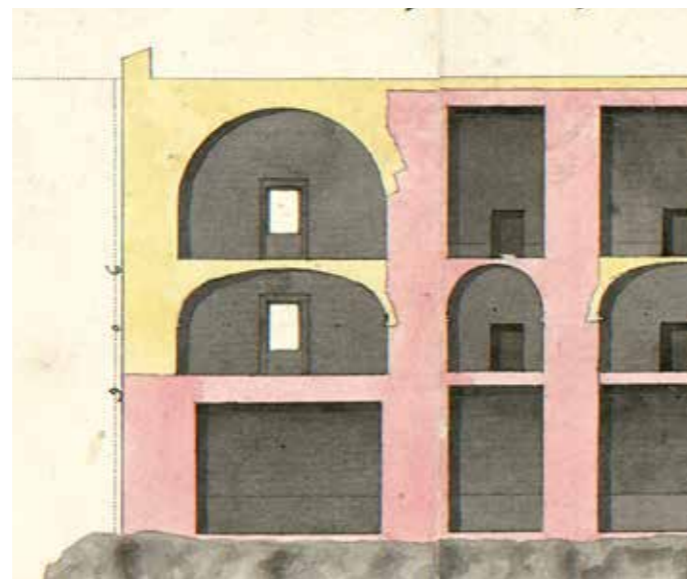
Plano de Suchet. Detalles de la vista y la planta. 1812.
